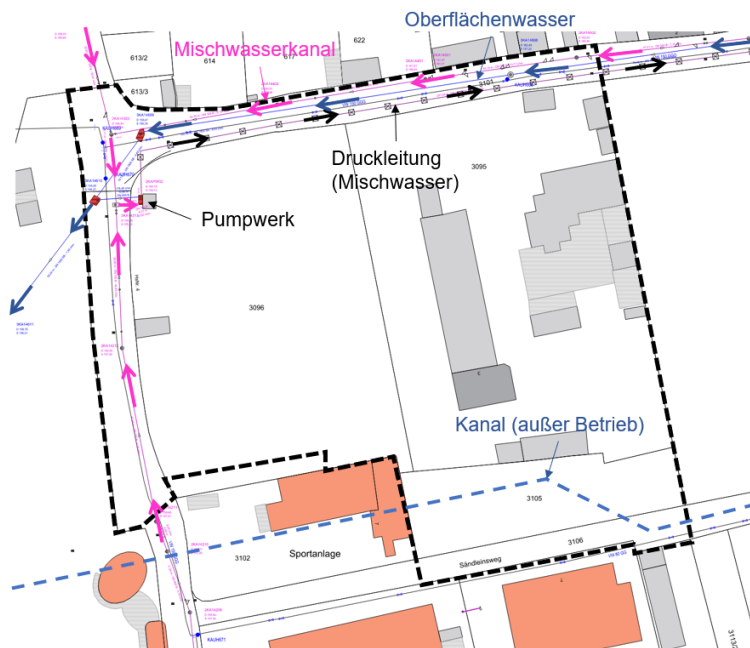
Lageplan örtliches Kanalnetz (Stadtwerke Karlstadt)
